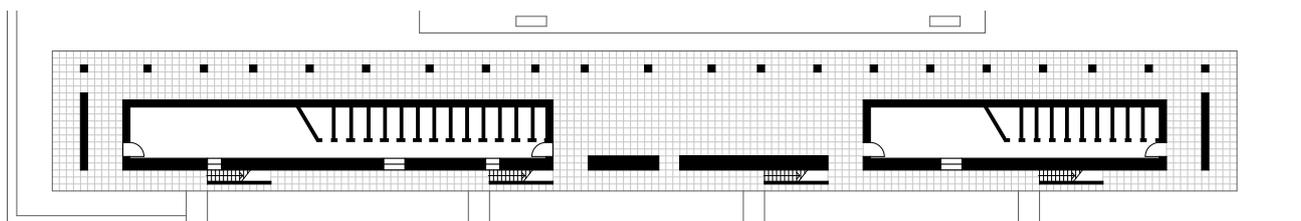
Grundriss Erdgeschoss, Sozialer Wohnbau, Figini und Pollini, 1941
